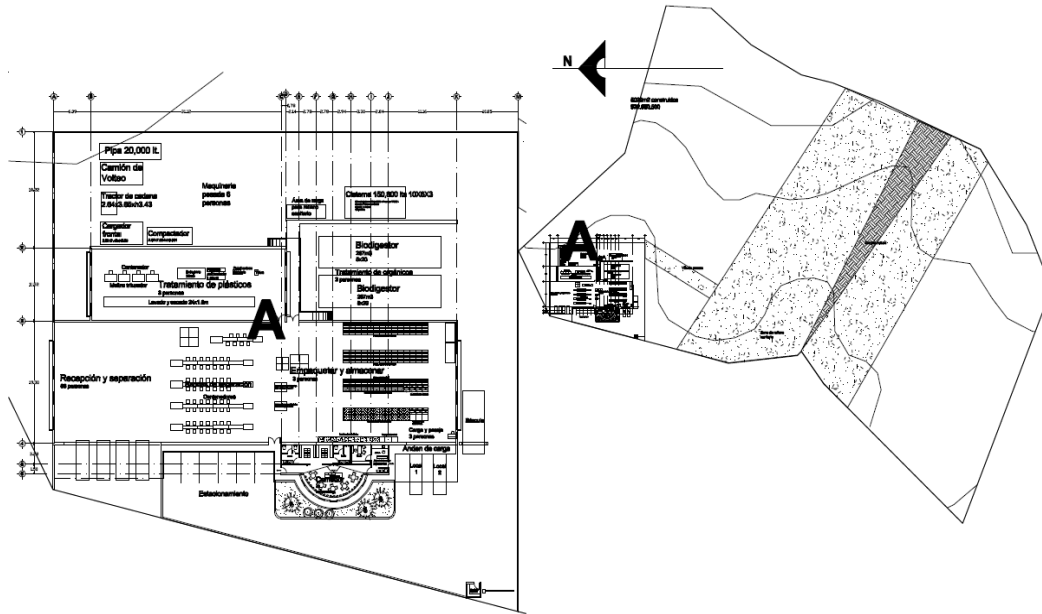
Planta de Tratamiento RSU y relleno sanitario
